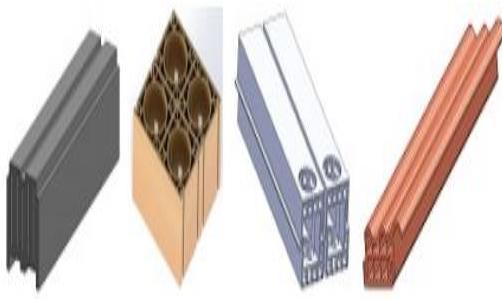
Отдельные элементы универсального набора (слева-направо: фундаментный блок, рядовой стеновой блок, балка перекрытия, кровельная плита)
